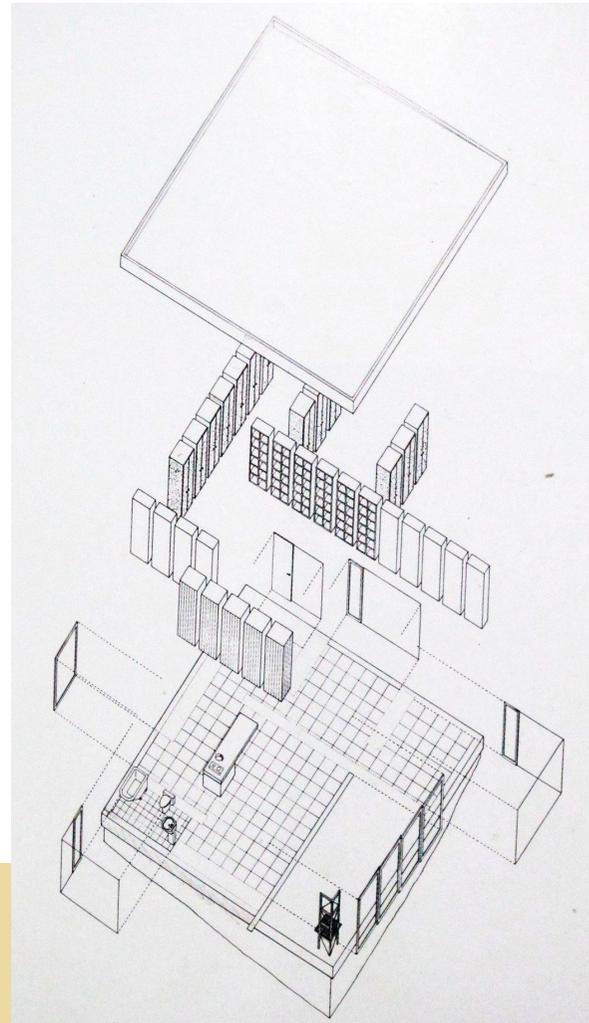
esploso assonometrico della Furniture House 1, Shigeru Ban, 1995 (a destra).
